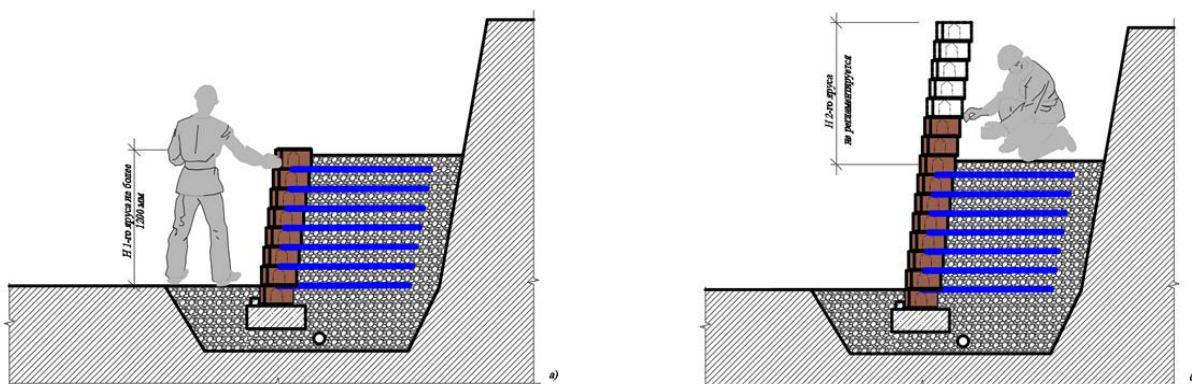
Принципиальная схема устройства подпорной стены по ярусам по второму способу: а) кладка стен первого яруса с лицевой стороны стены с щебеночной отсыпки; б) кладка стен второго яруса с поверхности дренажной насыпи.
